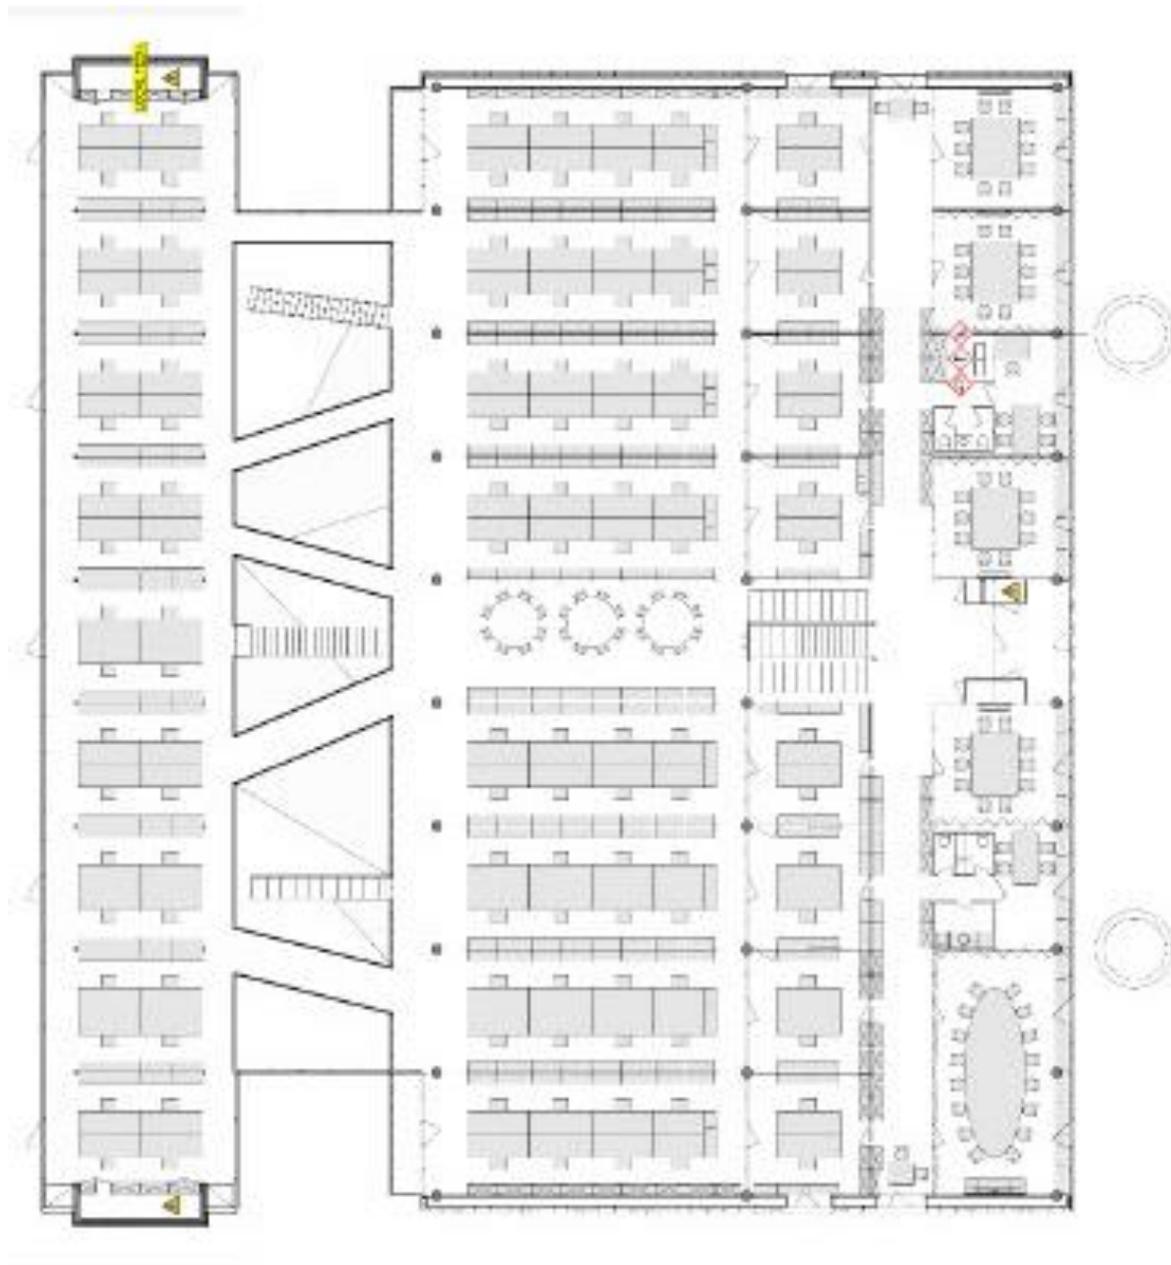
1 : Plan du rez-de-chaussée de l'entreprise Greisch (Source : Greisch sa)
